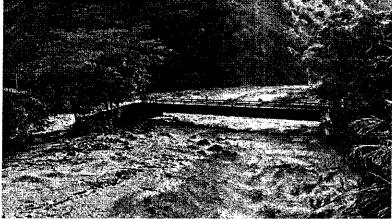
Puente de Viga de Concreto - Perfil Aguas Abajo
